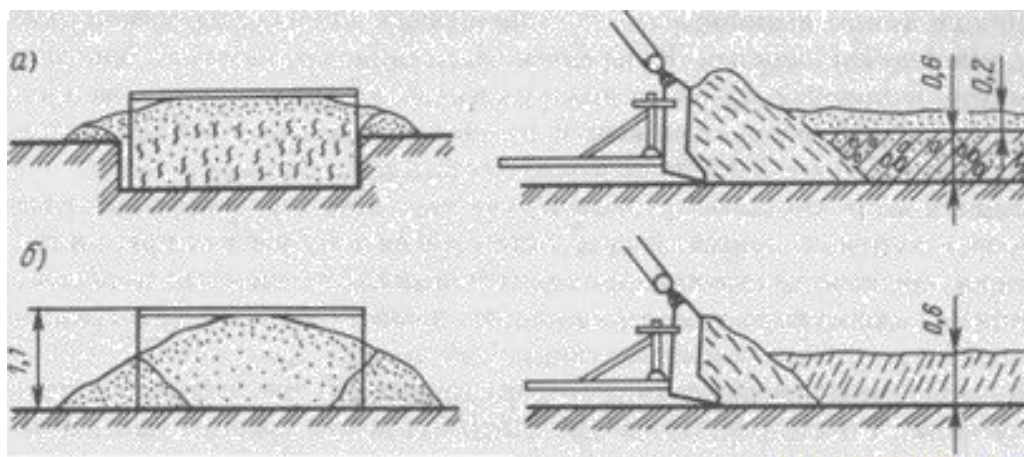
Схемы перемещения грунта бульдозерами по траншеям
